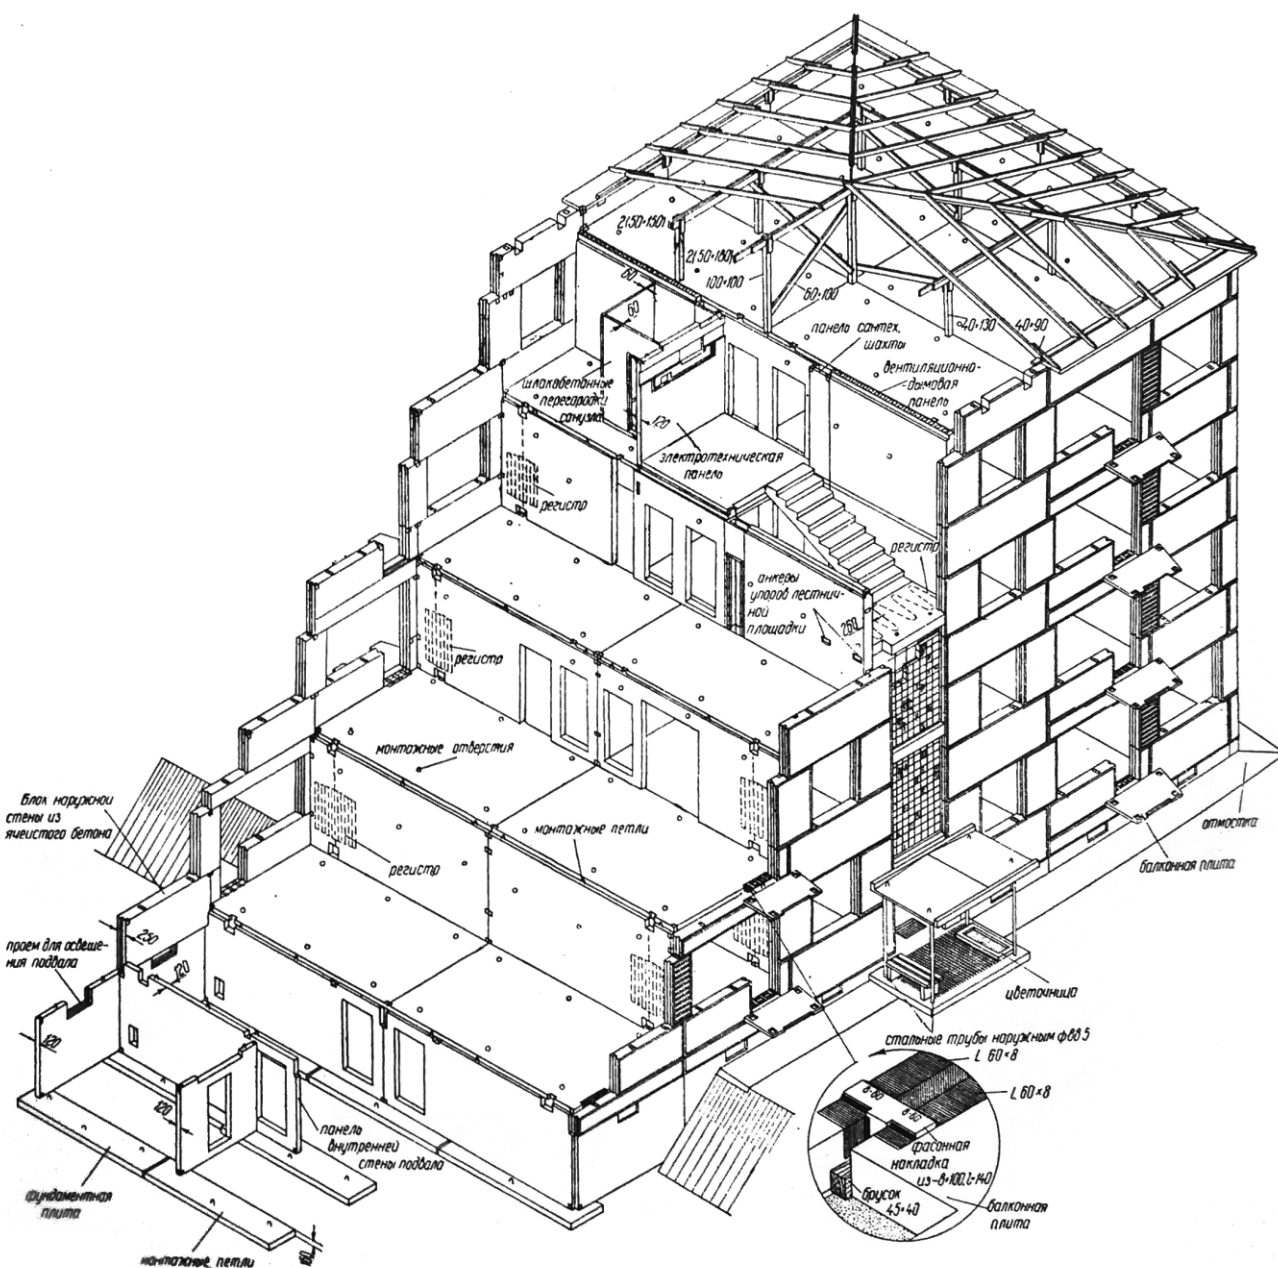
Здание с внутренними стенами из ж/б панелей и наружными стенами из газобетонных блоков
